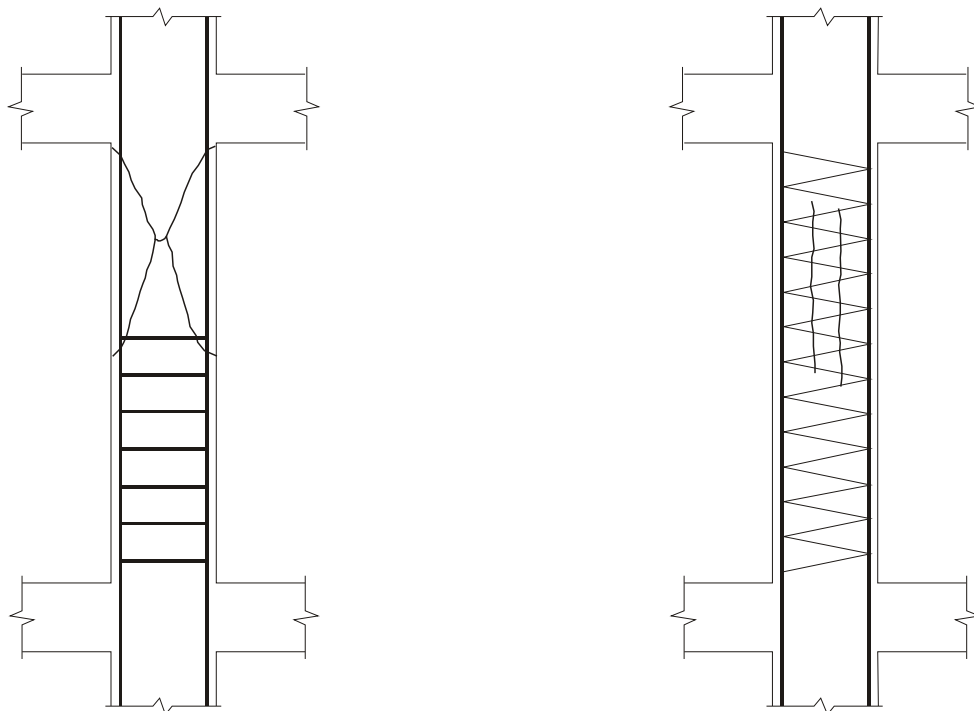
Fissuras de pilares submetidos a compressão axial
